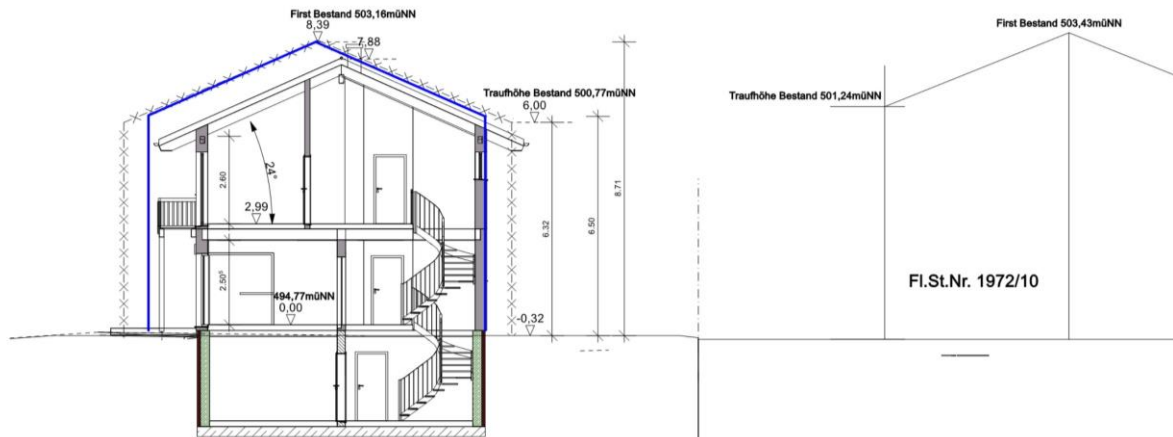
Schnittzeichnung, Quelle: Regnauer Hausbau GmbH & Co.KG,
